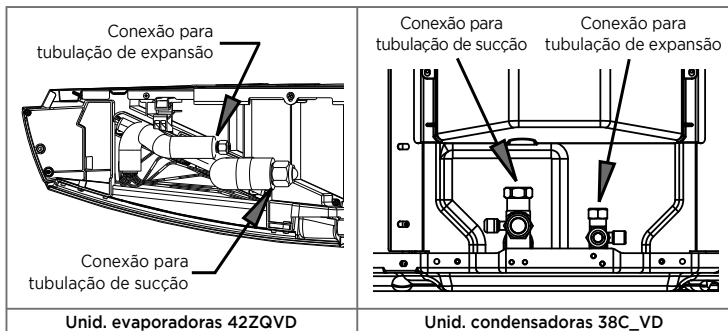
CONEXÕES DE INTERLIGAÇÃO
